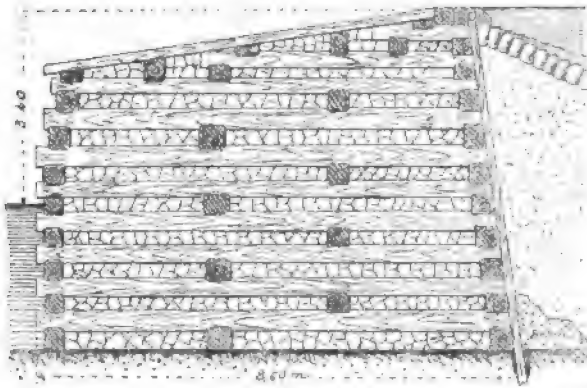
Steinkistenwehr aus gezimmerten Hölzern, im Schuylkillflusse bei Plymouth in Pennsylvanien (erbaut 1858). Dasselbe hat eine Kronenbreite von 1,22 m, eine Gesamtbreite von 5,49 m, eine Höhe von 3,8 m und eine Höhe der Wehrkrone über dem Niedrigwasser von 2,36 m. Es ruht auf Felsboden, ist auf der Rückseite mittels einer Spundwand gedichtet, und mit Stein- und Erdmaterial hinterfüllt.
